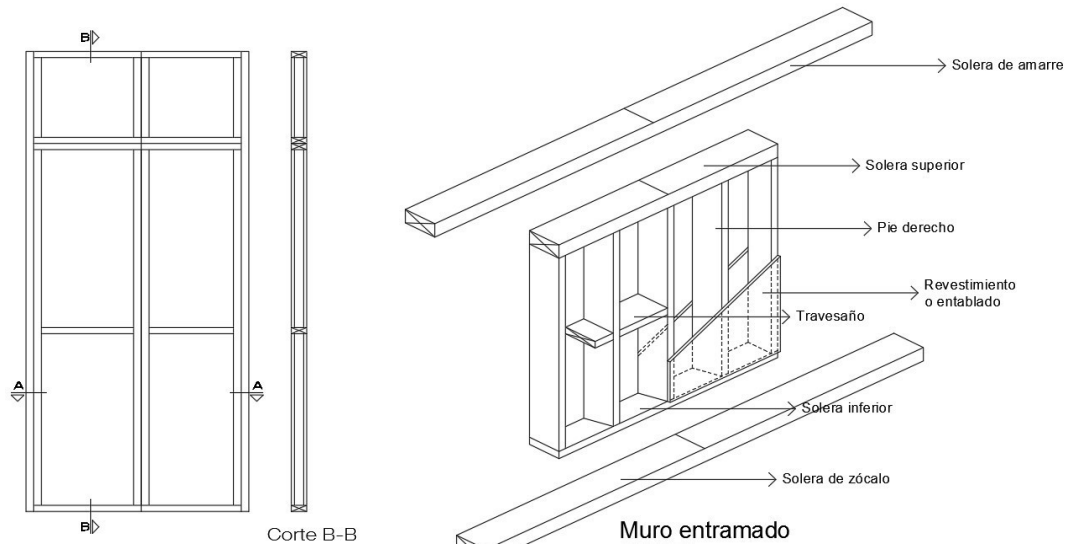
Painel estrutural e detalhe do muro. Fonte: Elaborada pela autora.
